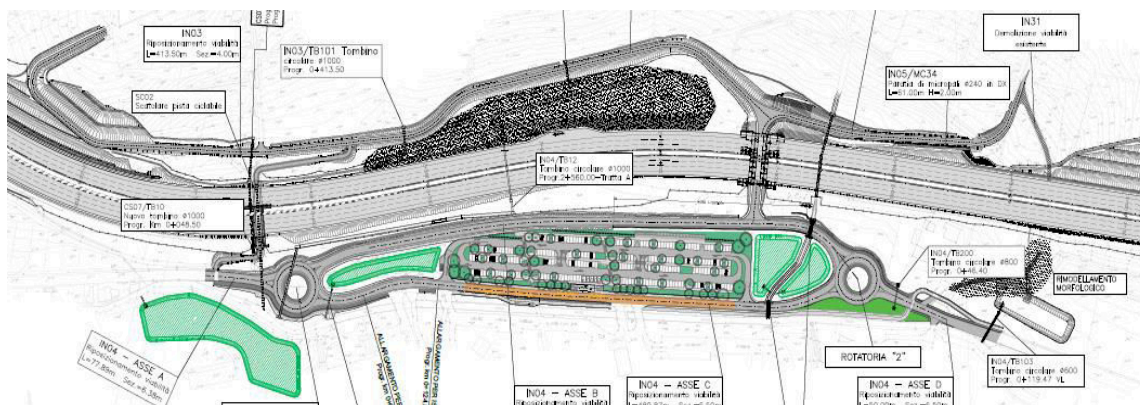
Planimetria soluzione progettuale proposta (Fonte: lista di controllo)
